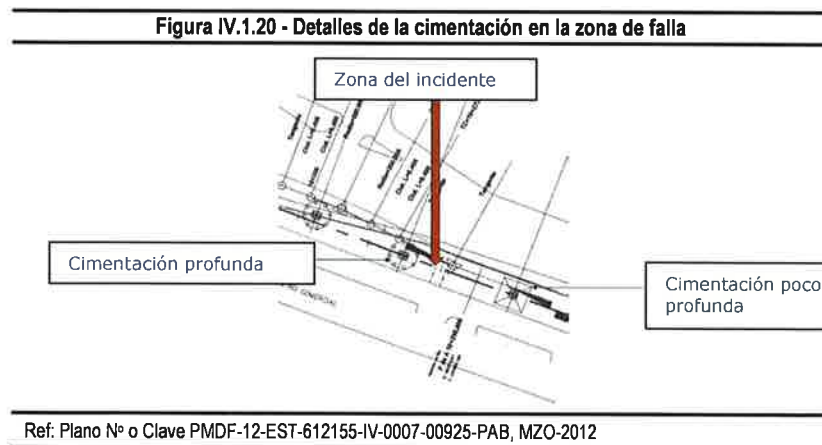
Detalles de la cimentación en la zona de falla
